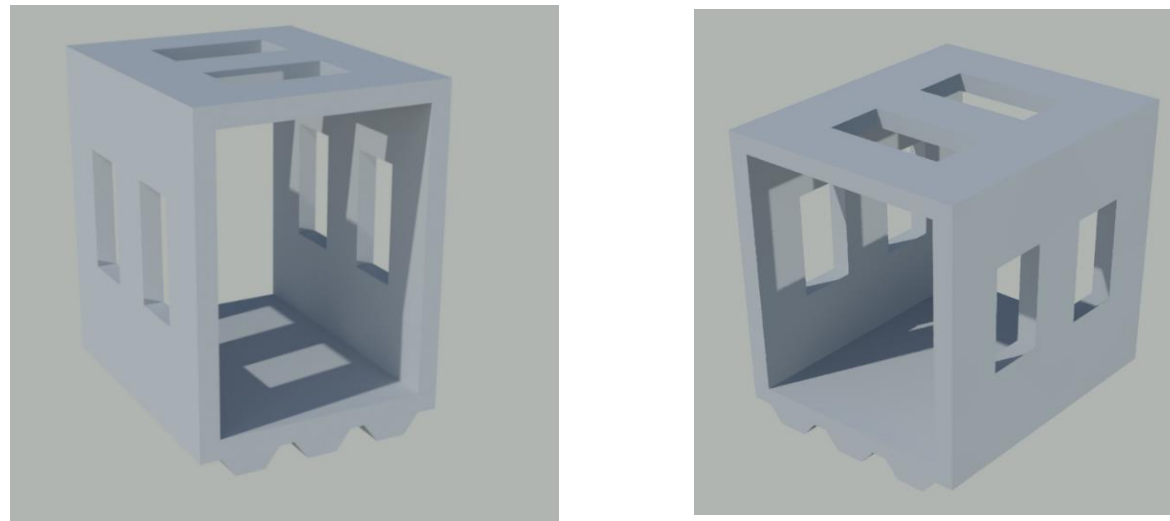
Vista 3D de la solución adoptada. (Fuente: plano 7.2, 2023)
